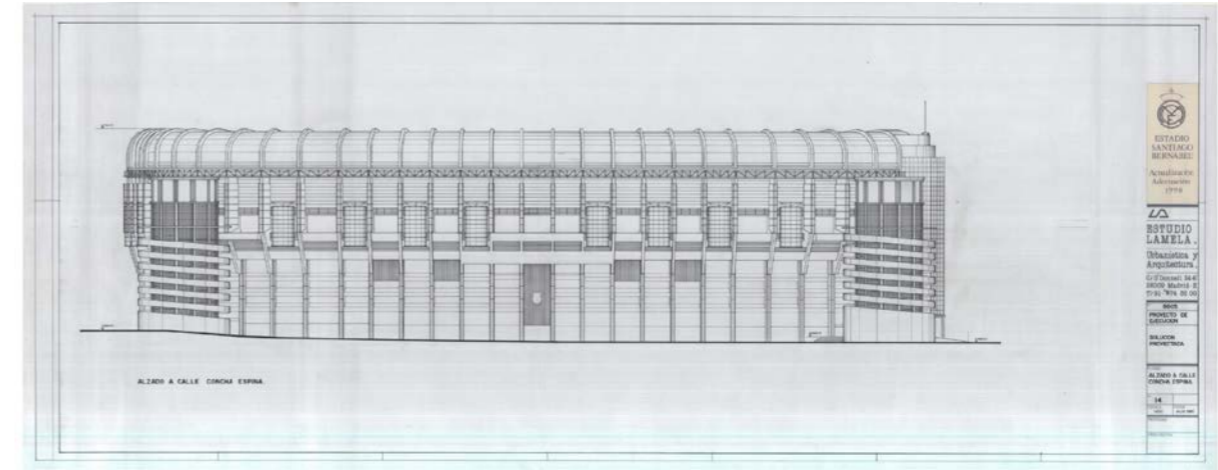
Alzado sur del proyecto de reforma de 1992 del Santiago Bernabéu.
